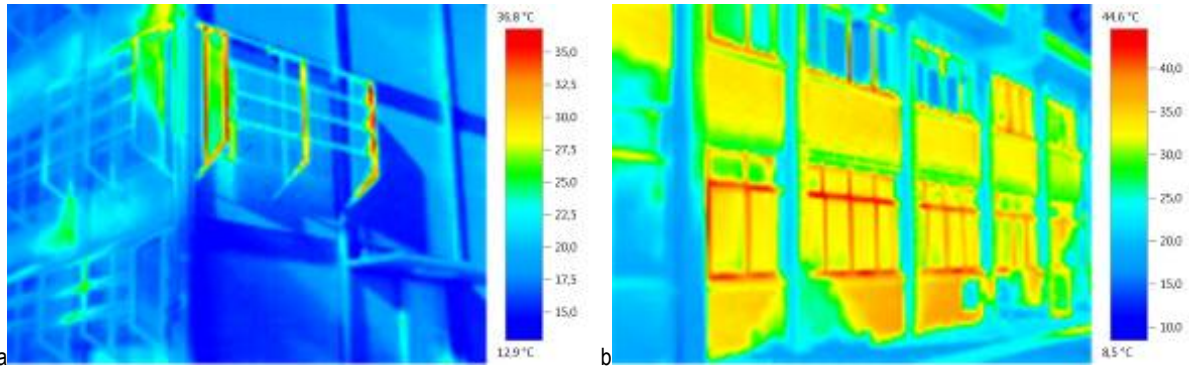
Termografía exterior testo 881-1 IRSoft, mes de julio: a. G1 – fachadas NE/SO; b. L1 – fachada NNO.
